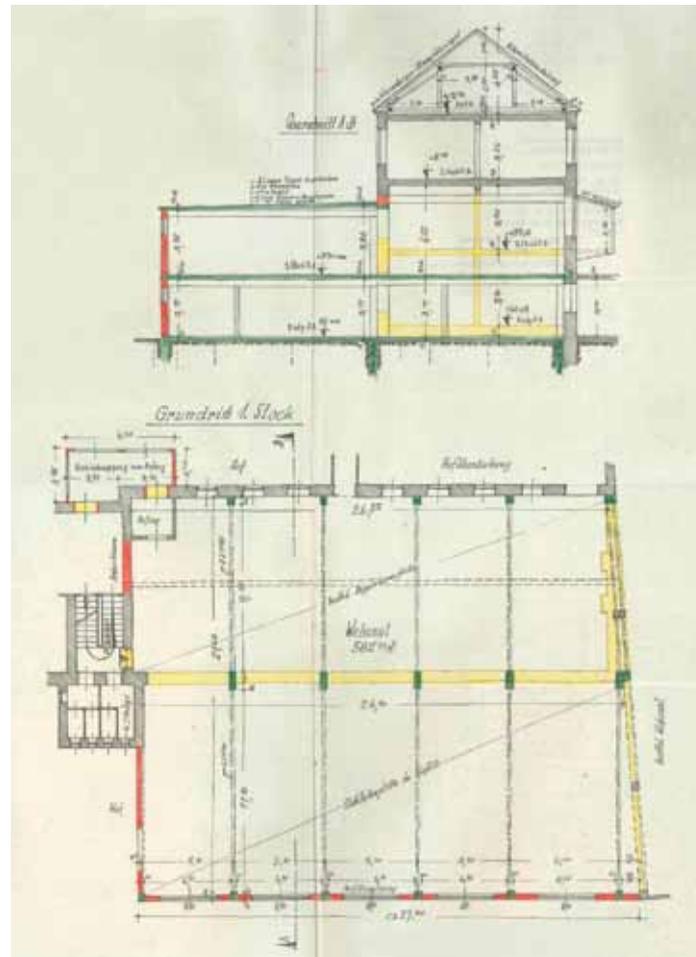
Grundriss und Schnitt zum Zubau des neuen Websaales mit Umbaumaßnahmen im Friedhofstrakt, 1965
